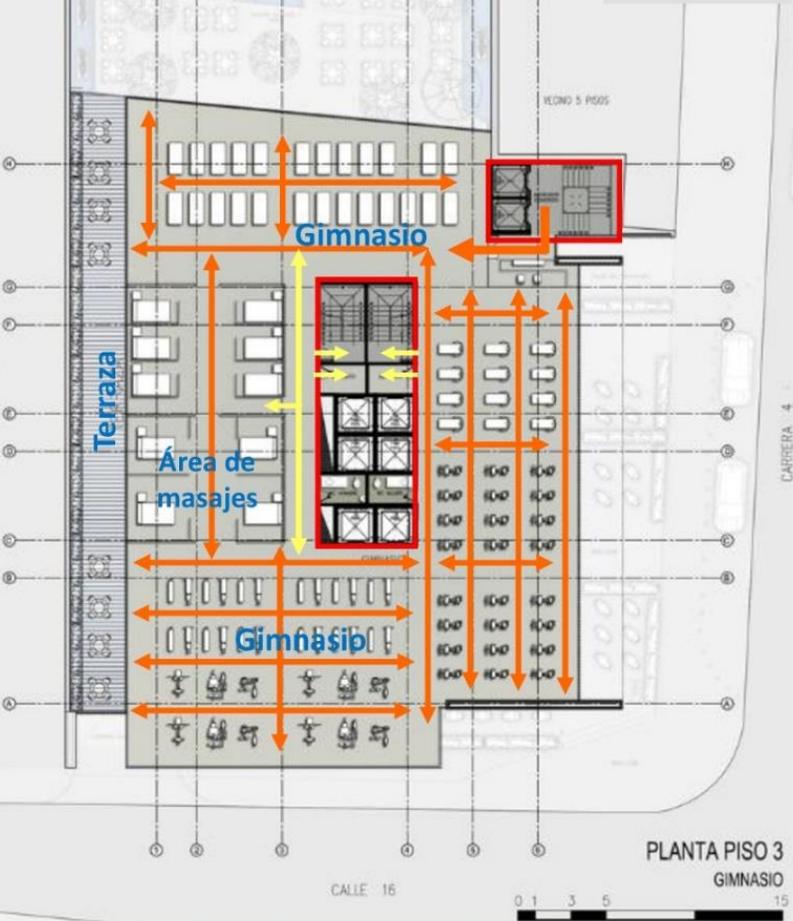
Tercera Planta escala 1:300 Fuente: www.archdaily.pe
